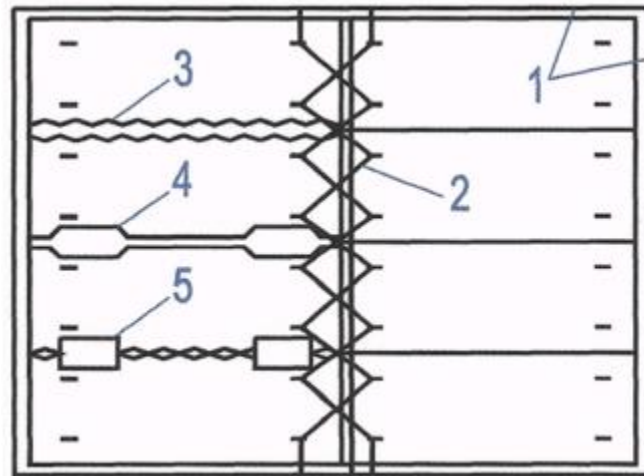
Конструктивные решения по обеспечению жесткости перекрытий и покрытий:
